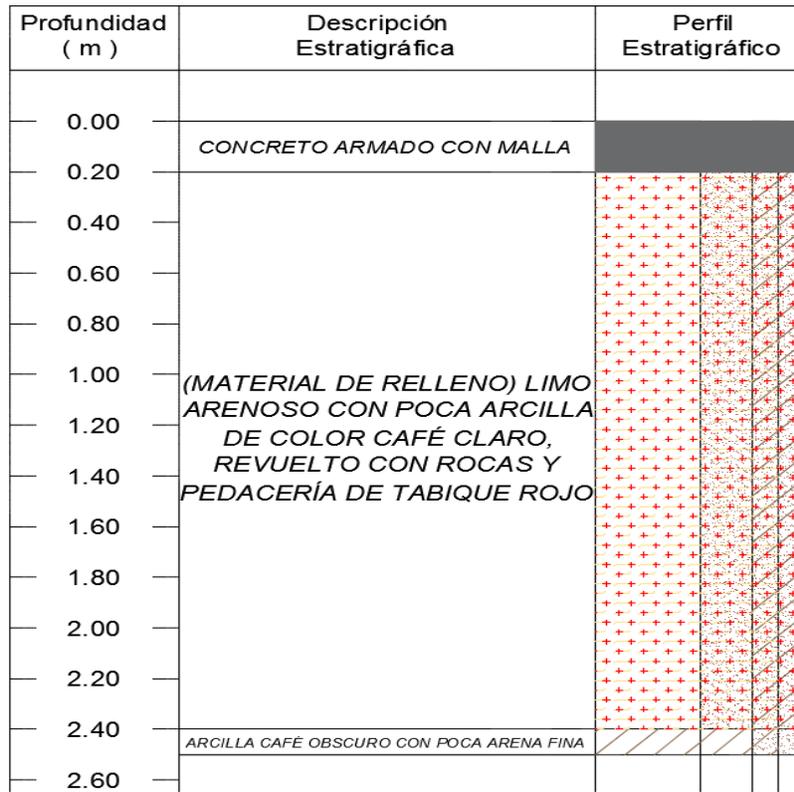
POZO A CIELO ABIERTO (PCA-3)
